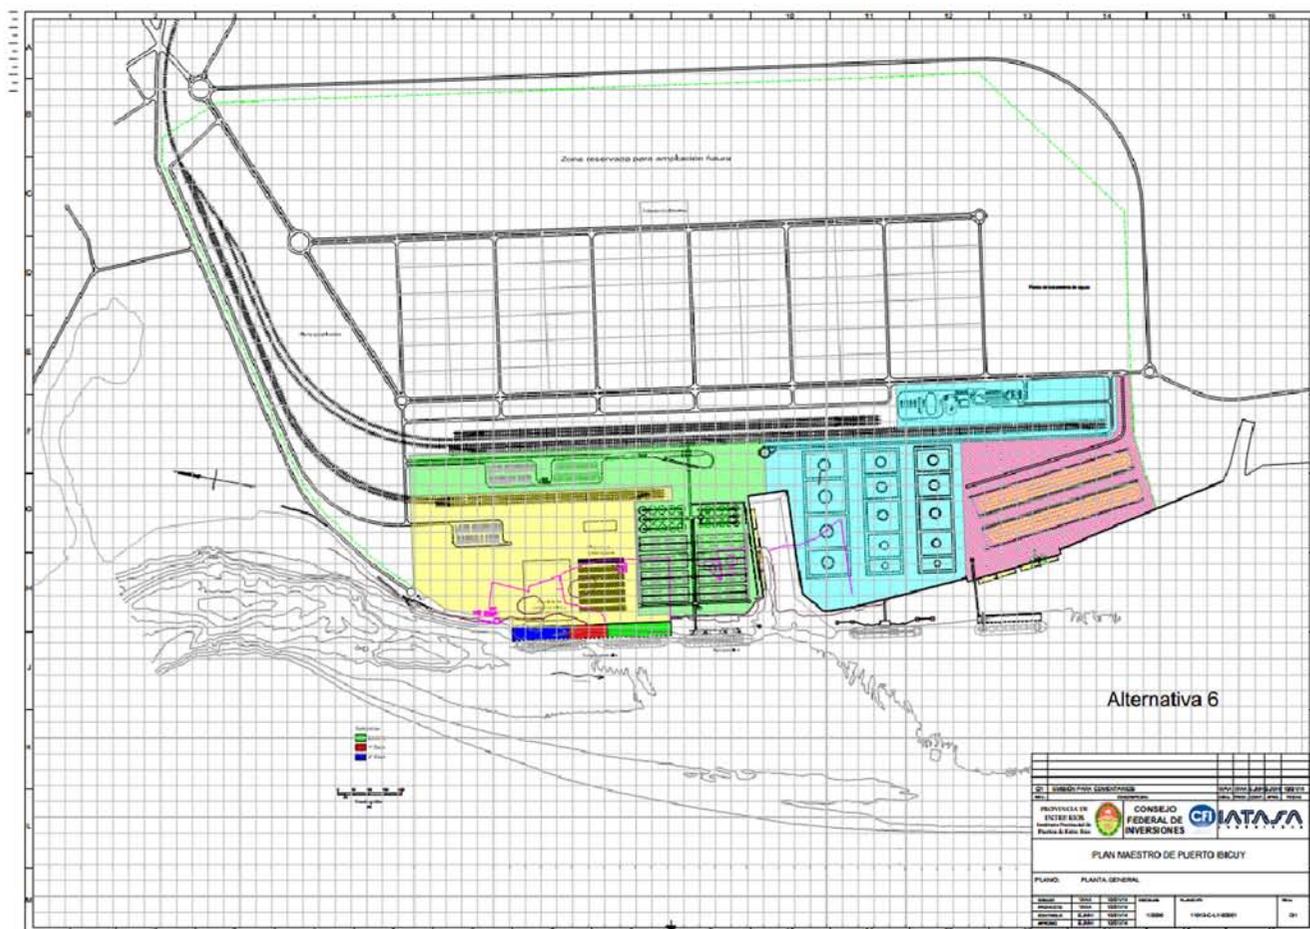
Plan Maestro Puerto Ibicuy, Plano Alternativa 6
